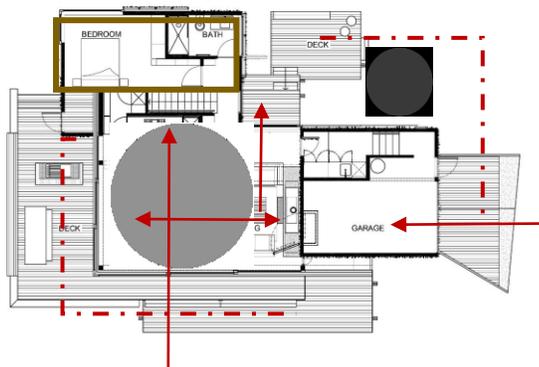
Primer planta, (2018) archidaily. modificaciones, Autoría propia
